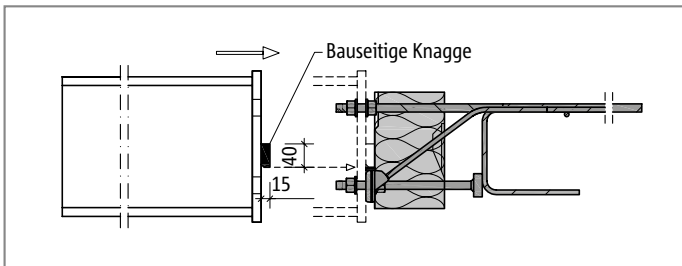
Montage des Stahlträgers mit bauseitiger Knagge
